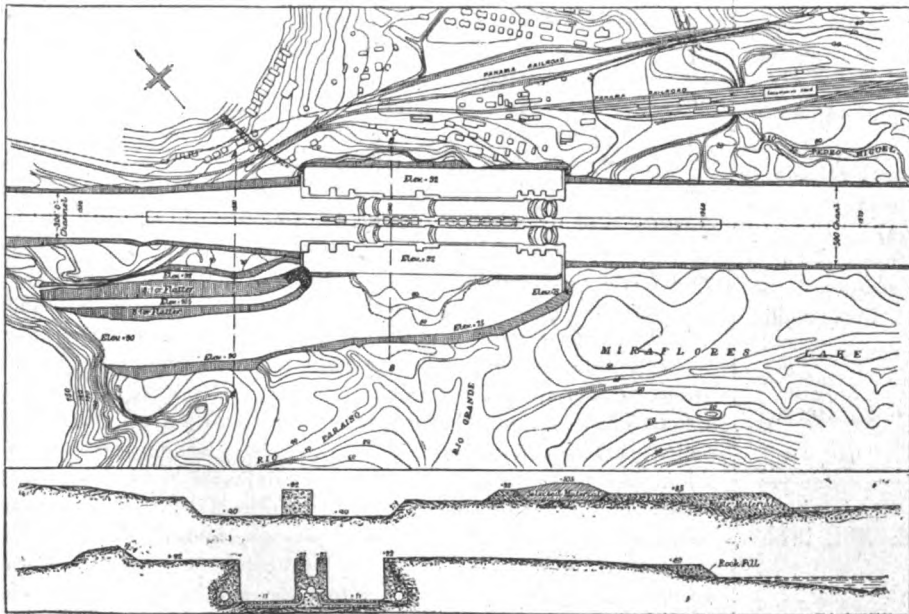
Cantiere di Pedro Miguel. - Planimetria.
